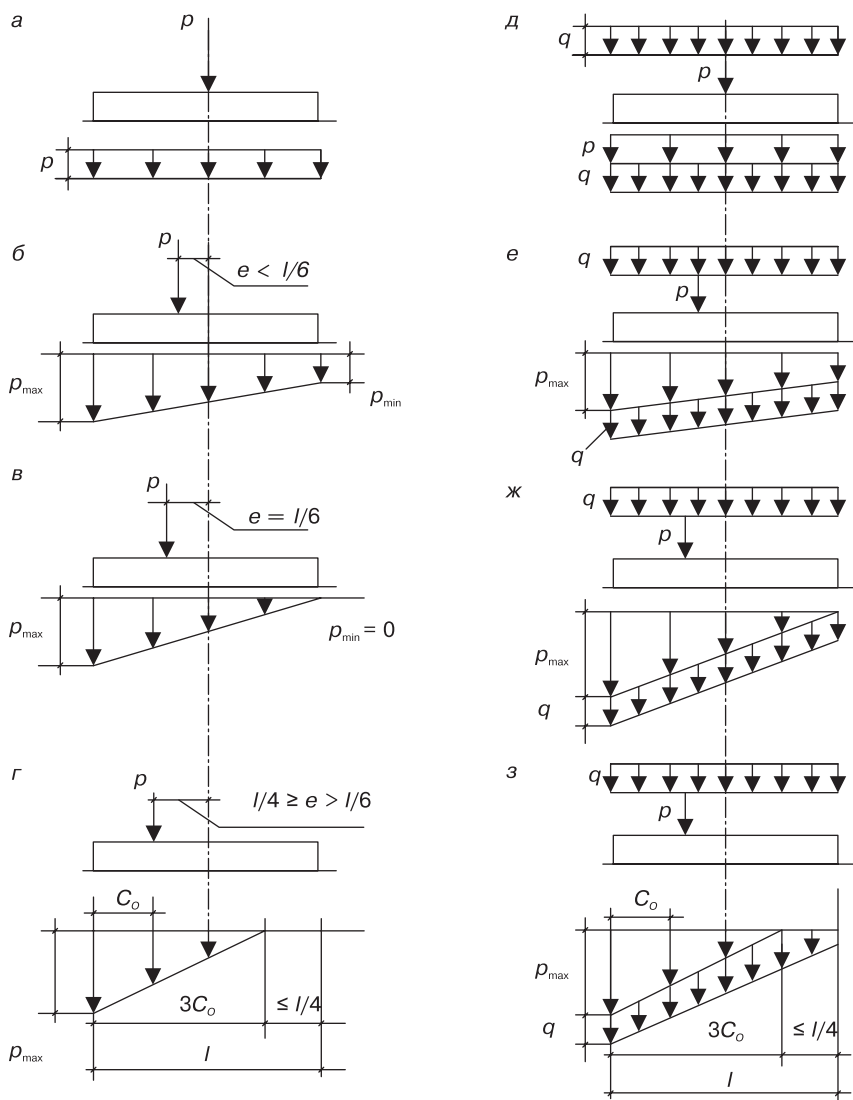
Эпюры давлений по подошве фундаментов при центральной и внецентренной нагрузках: а–г – при отсутствии нагрузок на полы;
